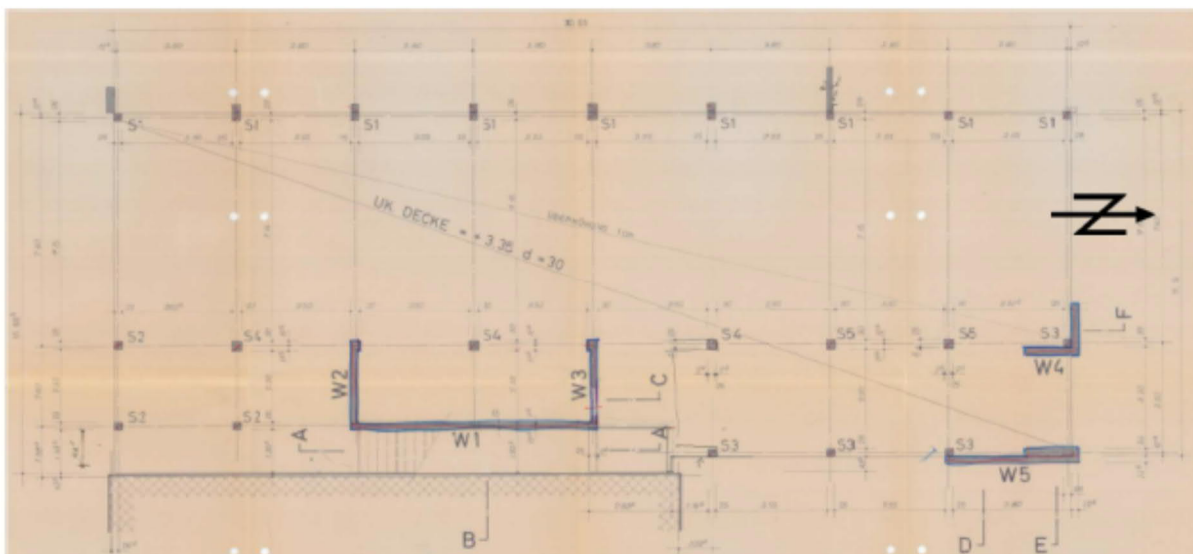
Plan horizontal de la partie 2 du bâtiment, rez-de-chaussée du bâtiment scolaire.
